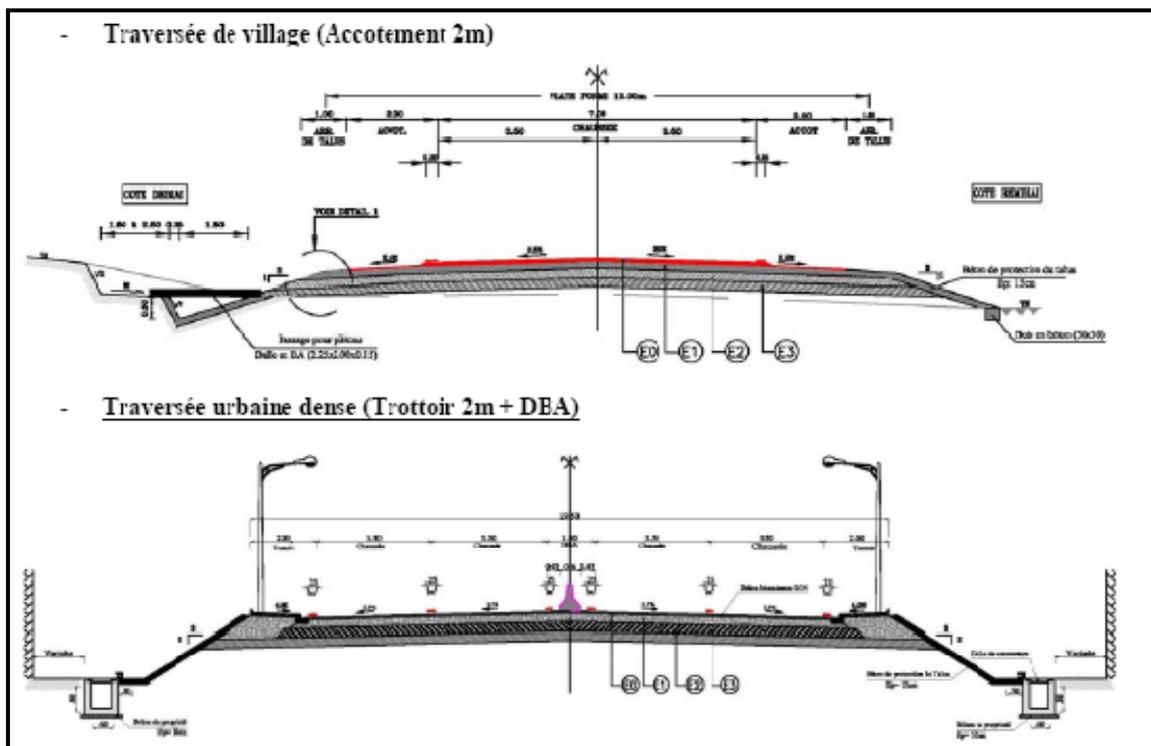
Profil en Travers type en section courante – Chaînons manquants – Section Tchadienne
